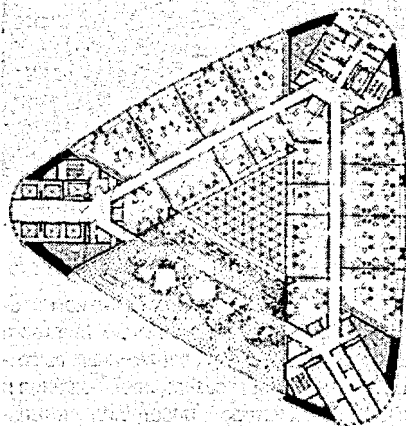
План здания Commerzbank во Франкфурте-на-Майне, 1997 г., арх. Н. Фостер
